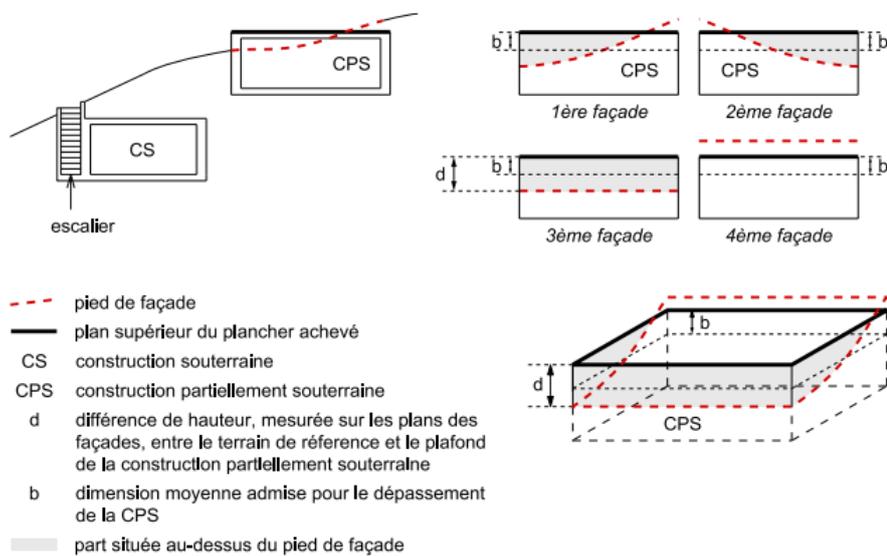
et 2.5 Constructions souterraines, constructions partiellement souterraines
